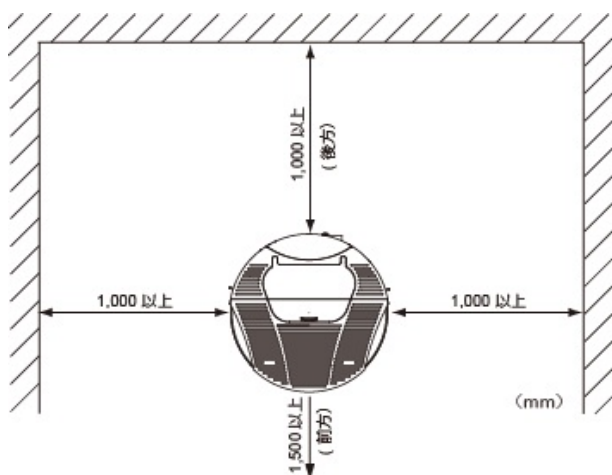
消防法等による前方・側方・後方の離隔距離（平面図）
